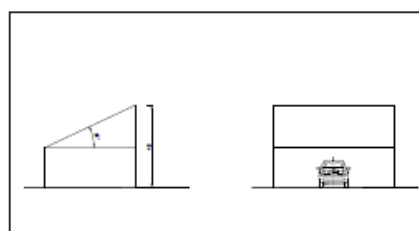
Planimetria complessiva del progetto delle pensiline con copertura integrante i pannelli fotovoltaici dei parcheggi
